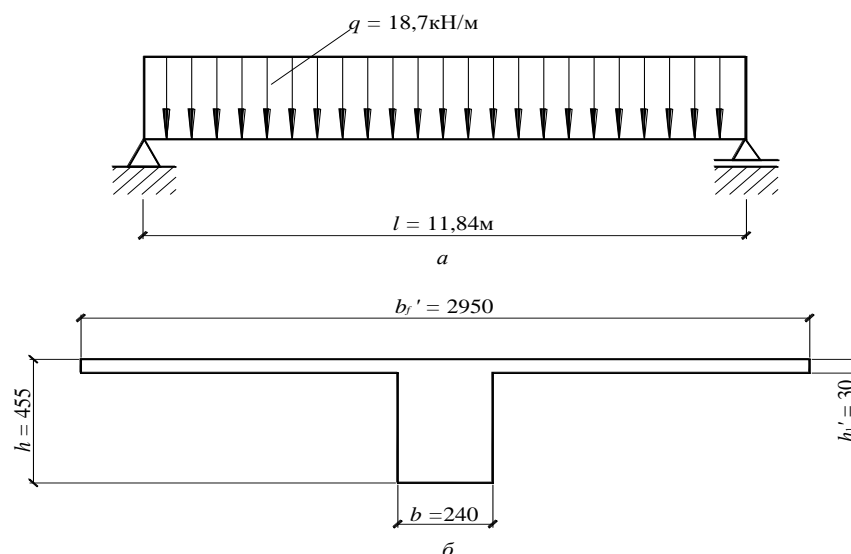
До розрахунку плити у стадії експлуатації: а – розрахункова схема плити; б – еквівалентний поперечний переріз.
